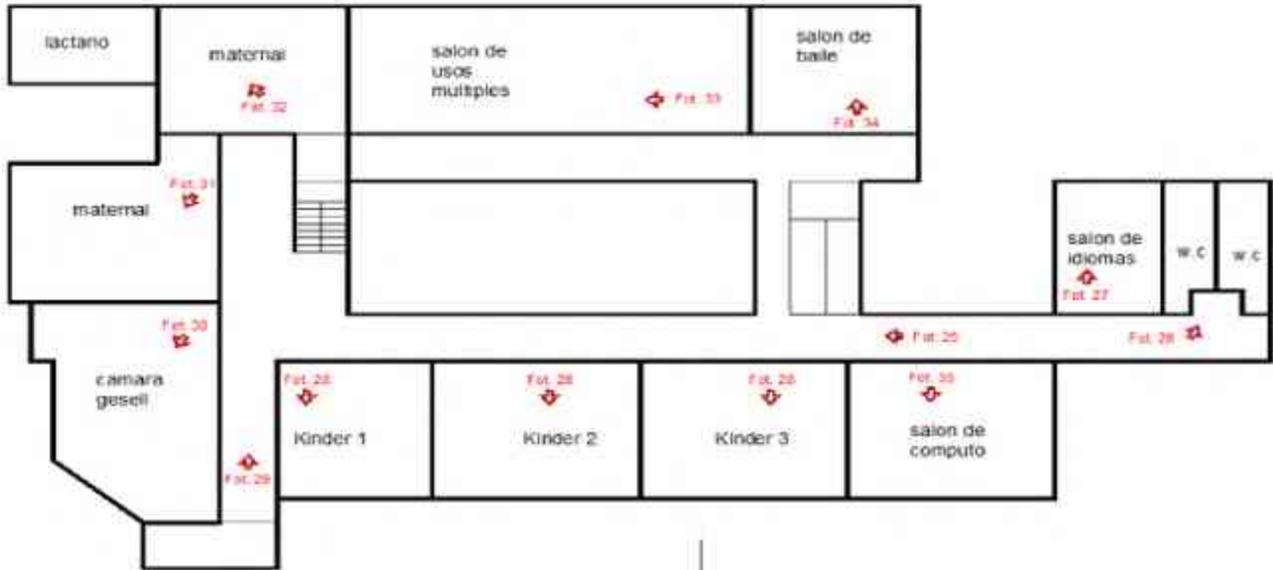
croquis arquitectónico del C.N.D.I de Zacapu Michoacán. Plano. Eguía. G. Luis. A.
